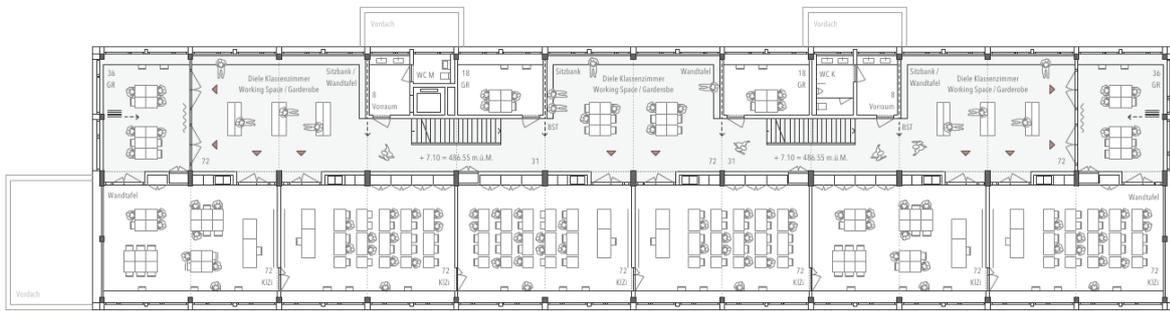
Neubau Sekundarschule, Grundriss 2. Obergeschoss
